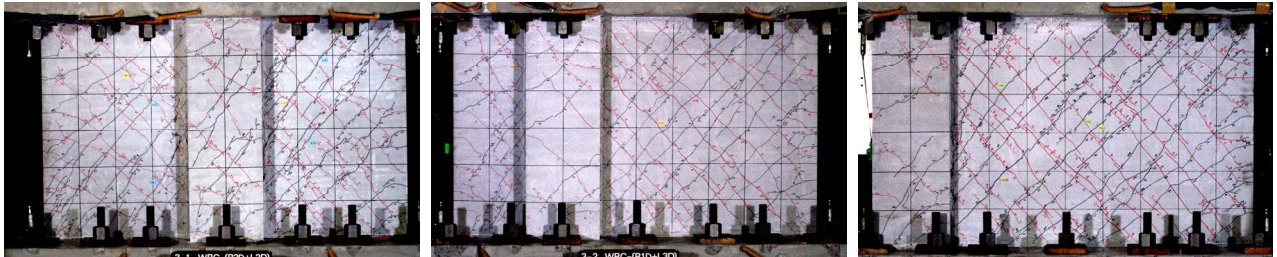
R=+1/800rad. (1回目)時のひび割れ状況
